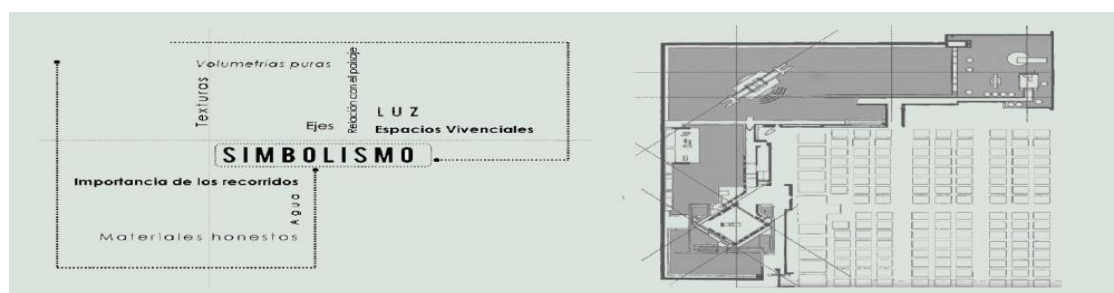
Diagramas arquitectónicos Cementerio de Brion.
